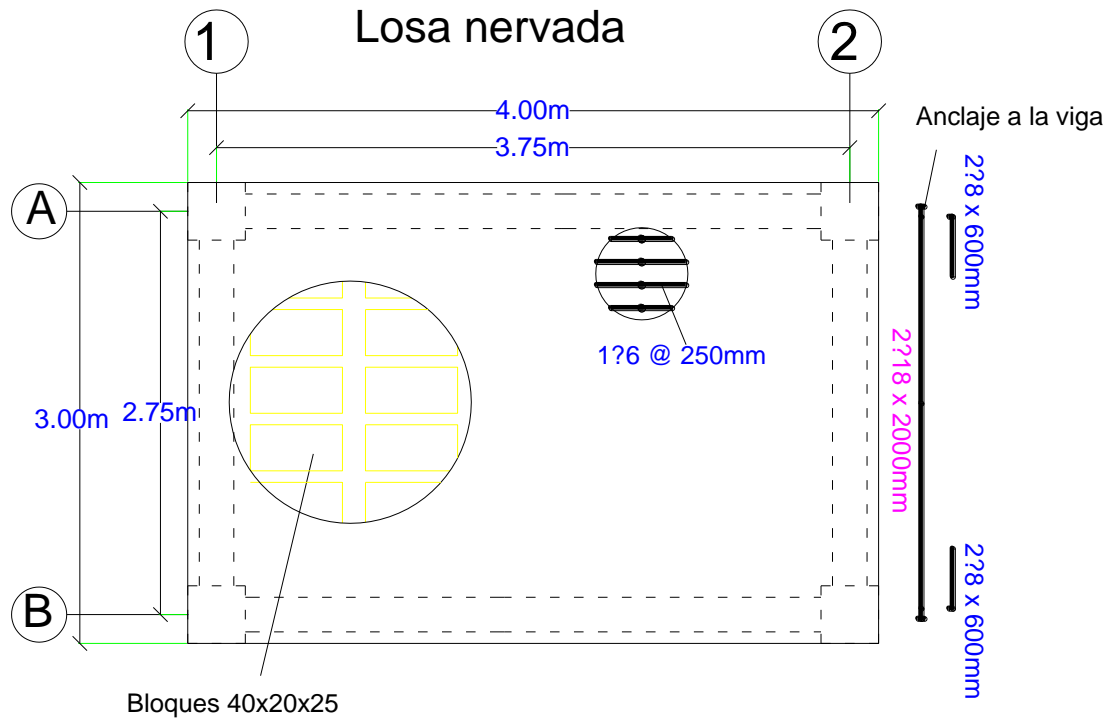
Se describen las dimensiones de la losa que sirve de cubierta para la caseta de instrumentos. Se detalla el acero de refuerzo y el tipo de bloque a usarse para el aliviar la losa.
